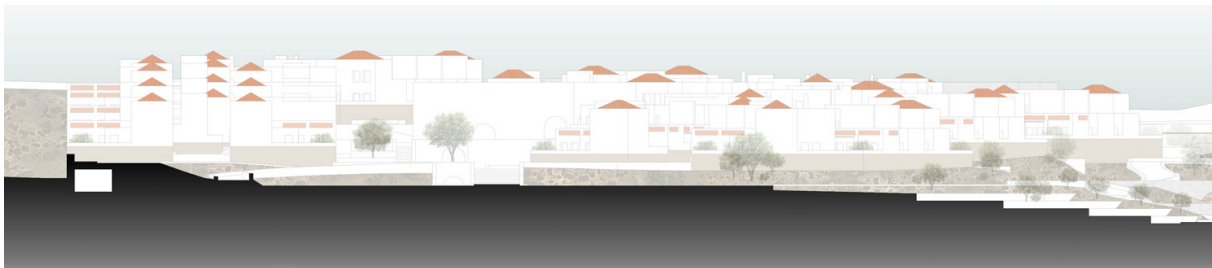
Corte sobre miradouro, espaço verde livre, anfiteatro 1:1000
